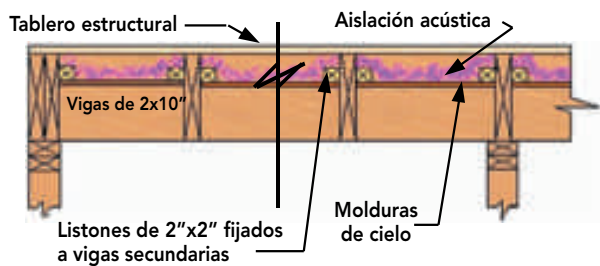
Corte de entrapiso que muestra las molduras fijadas a listones, quedando las vigas a la vista.
